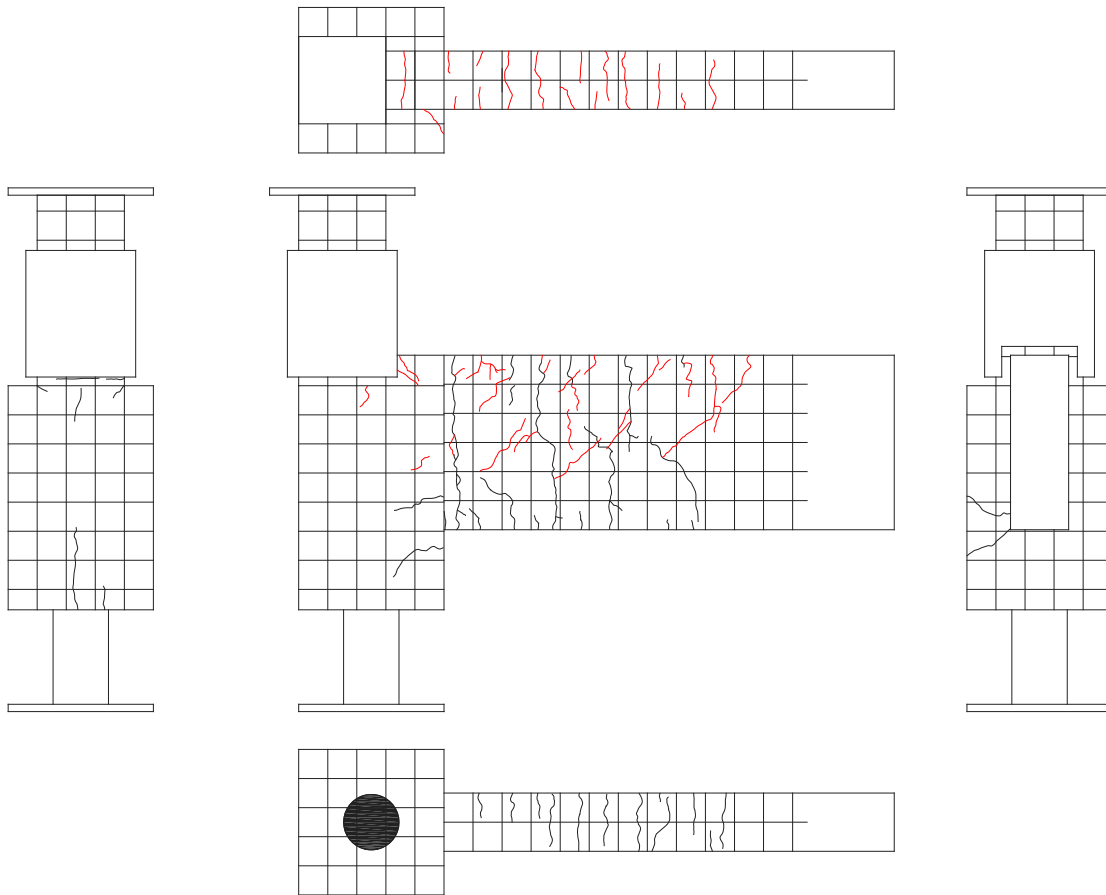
3. 92 試験体 C-2 ひび割れ状況 (1Cycle)
